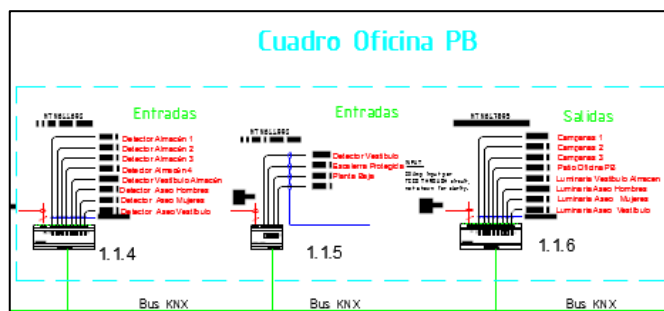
Elementos KNX de cuadro de Oficina Planta Baja
